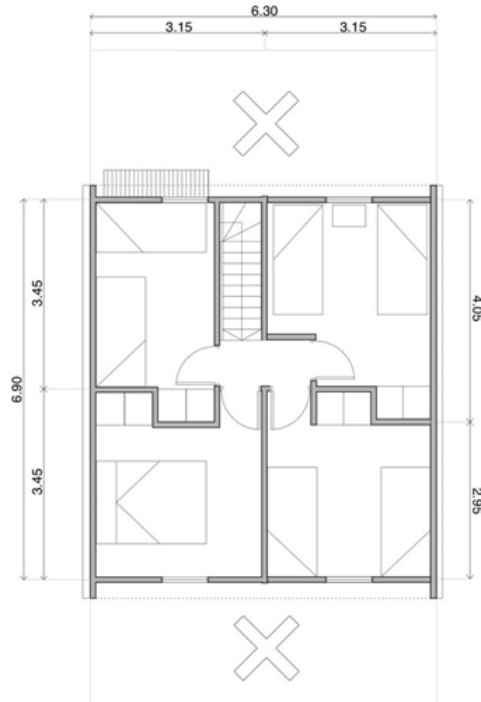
Villa Verde Housing Zemin kat ilk plan
